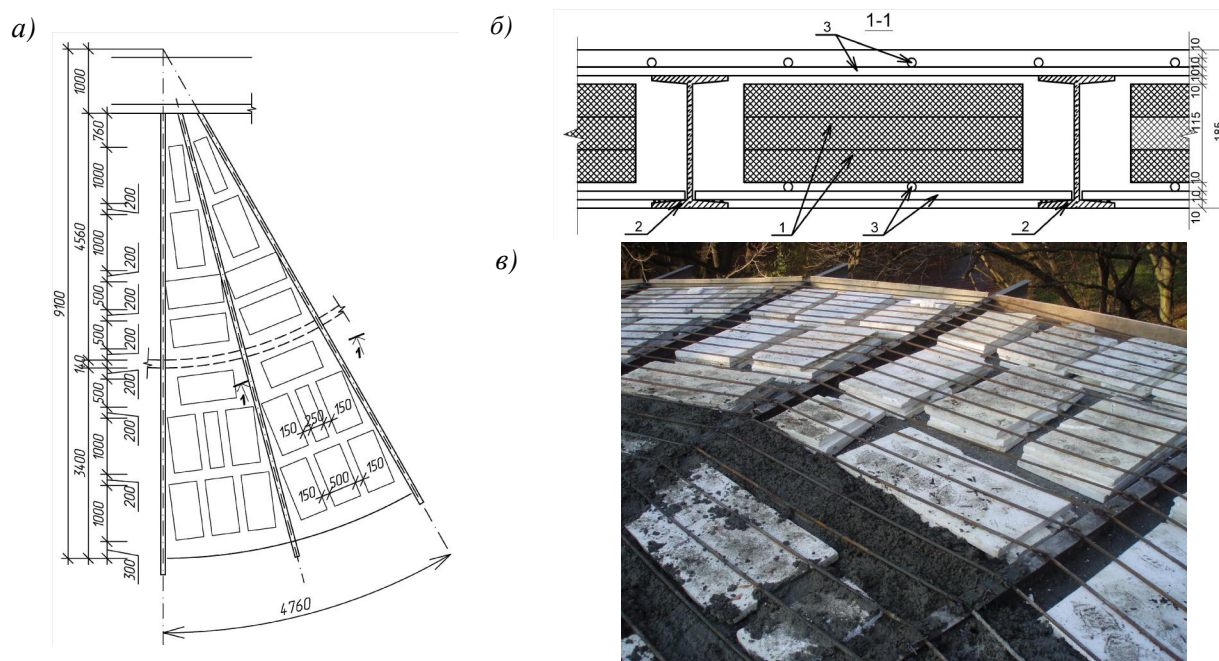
Фрагмент (а), місцевий переріз (б) і бетонування (в) круглого перекриття з пінополістирольними вставками: 1 – пінопластові вставки; 2 – металеві балки; 3 – арматура
